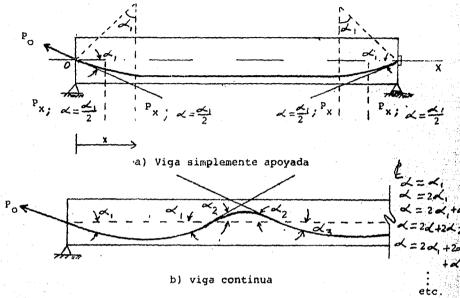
Variación angular en los tendones de presfuerzos de una viga postensada
